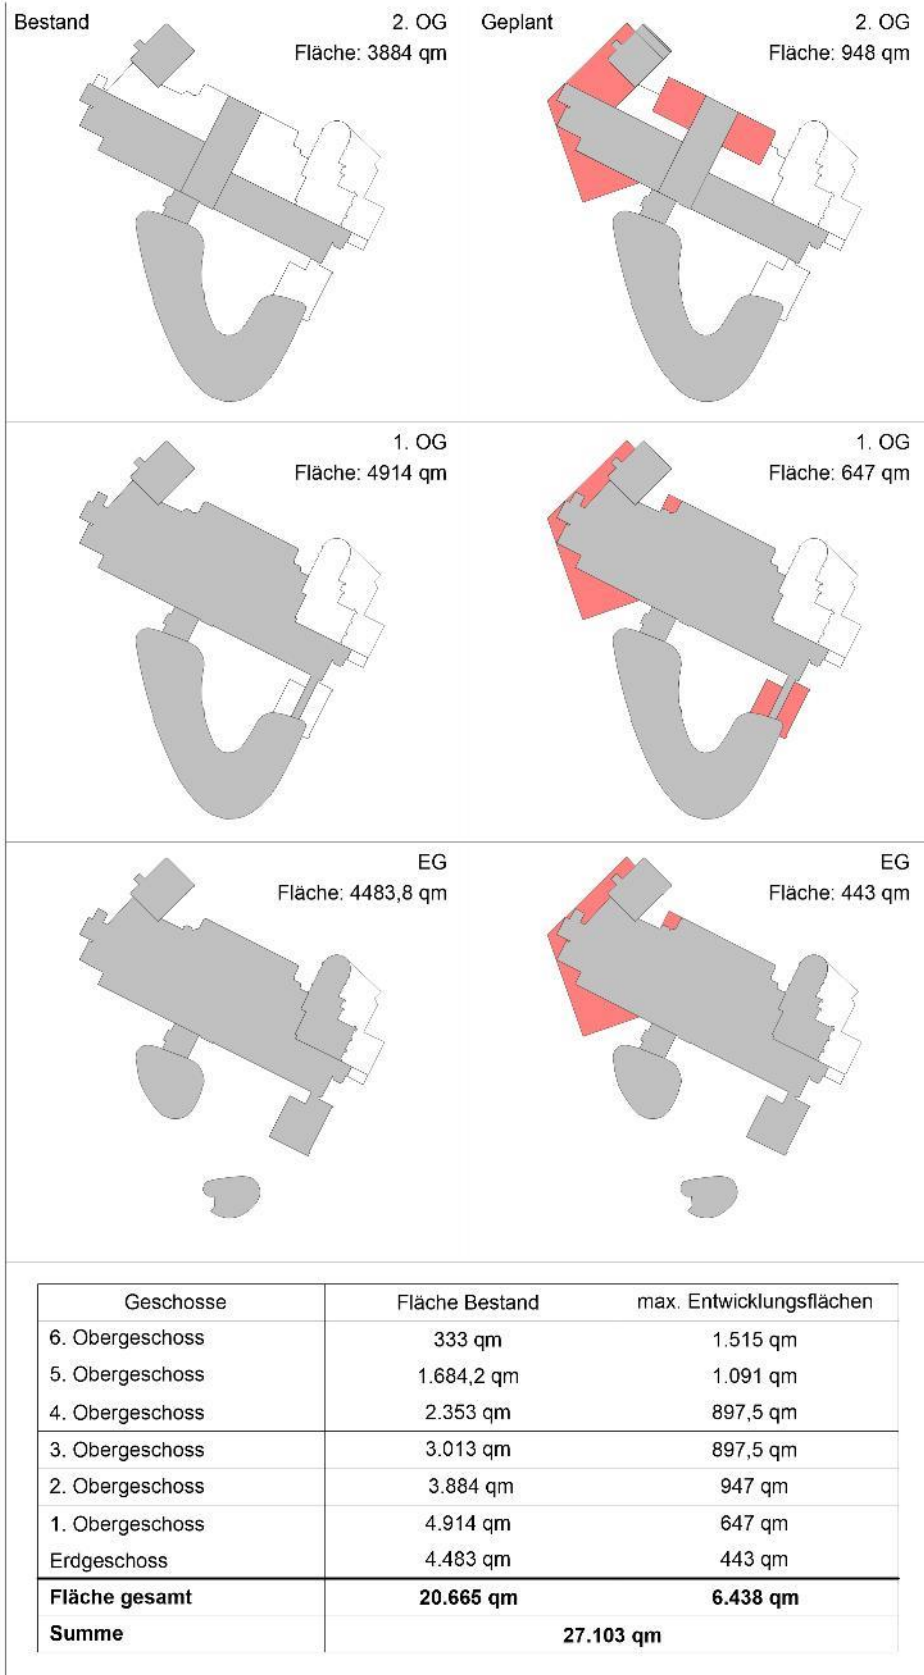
Darstellung der möglichen baulichen Erweiterungsflächen
